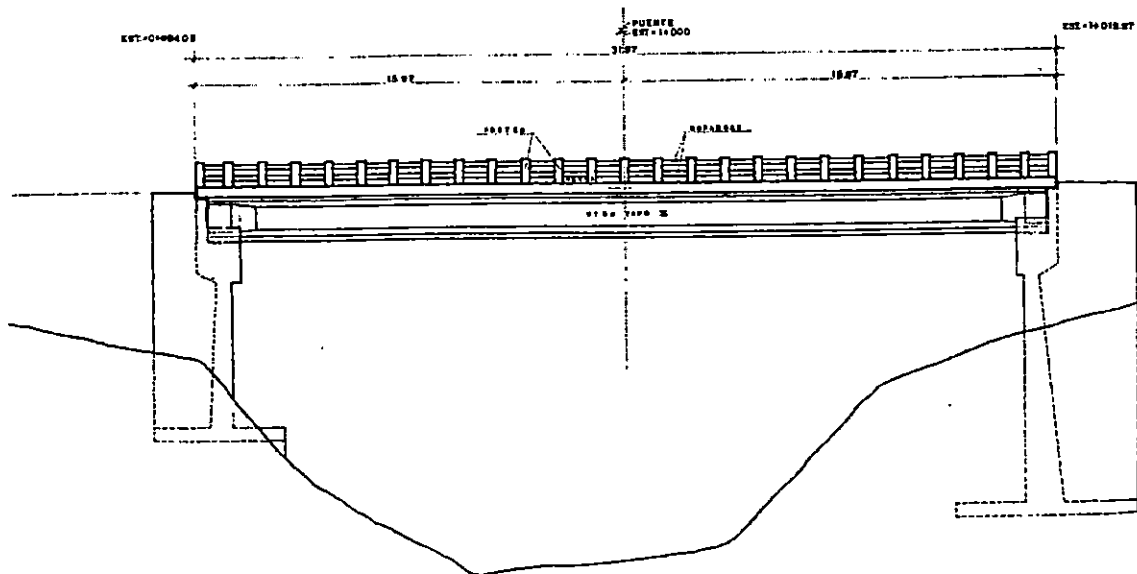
ELEVACION DEL PUENTE.
